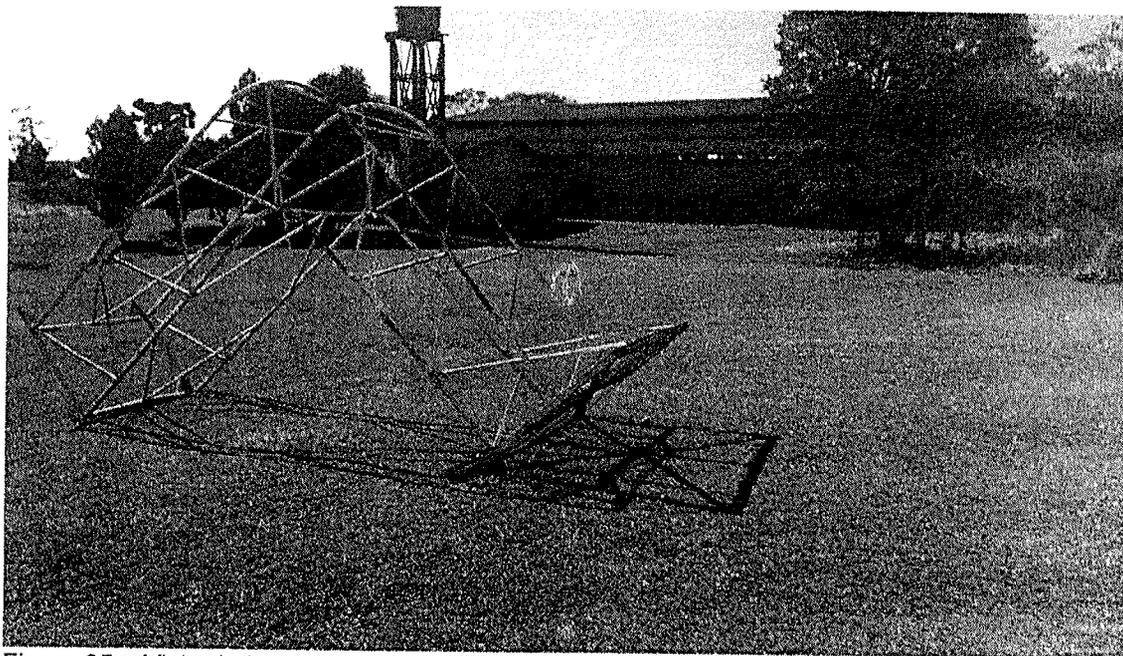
Vista do local de execução da obra direção sudoeste-nordeste.
